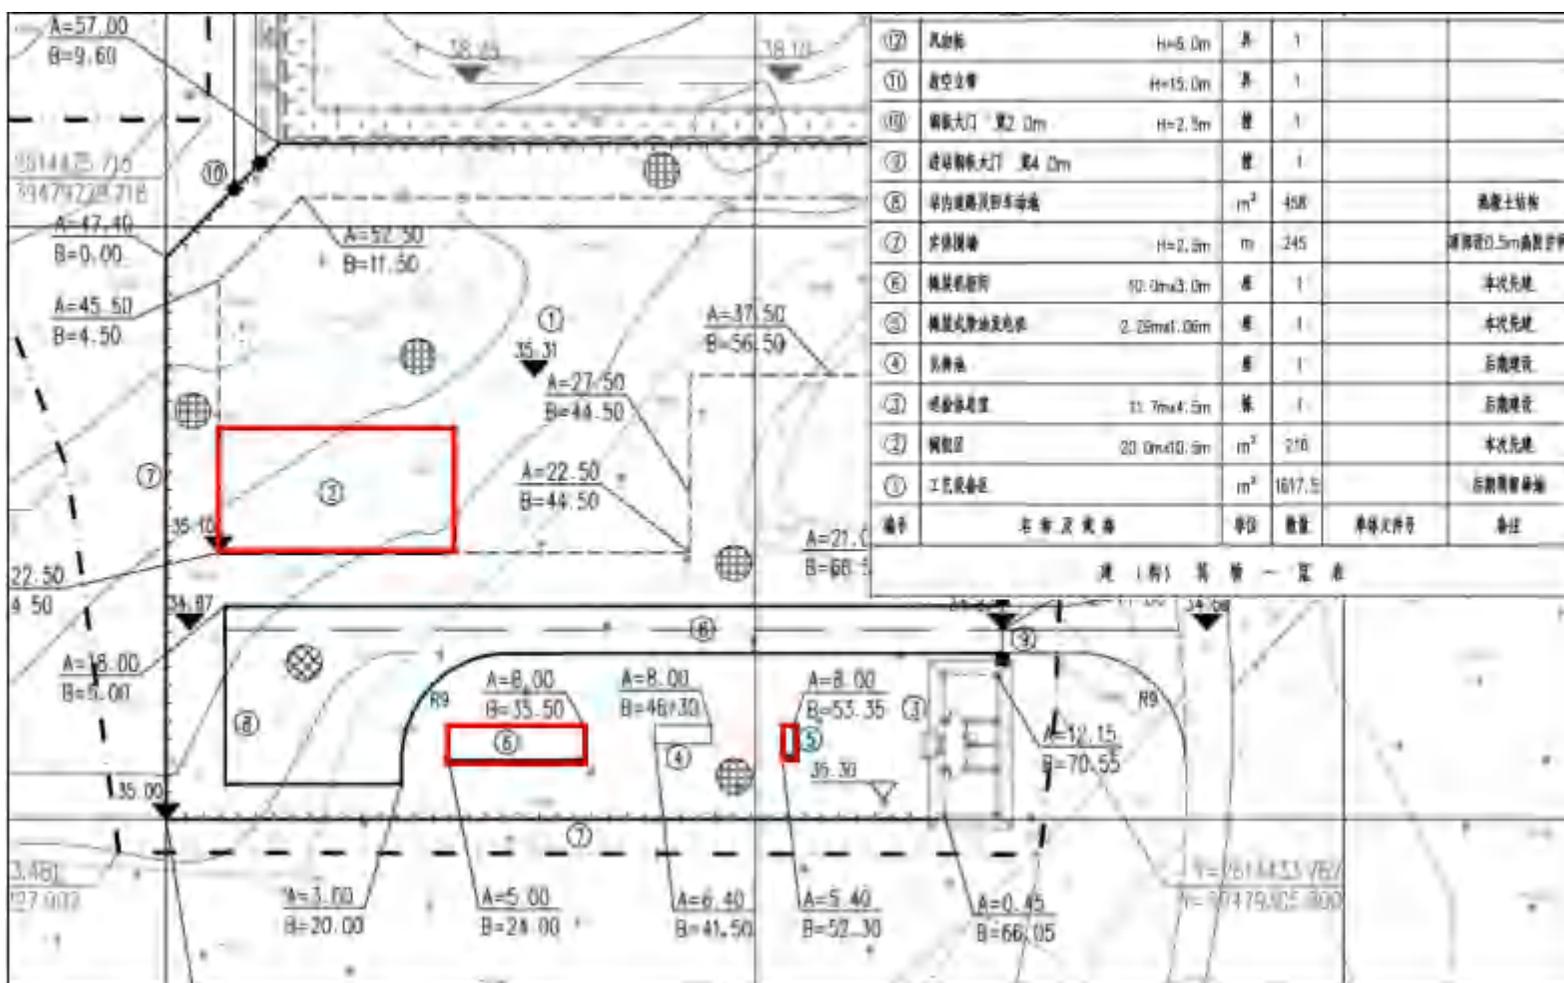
铁铺分输站平面布置图 (部分放大)
